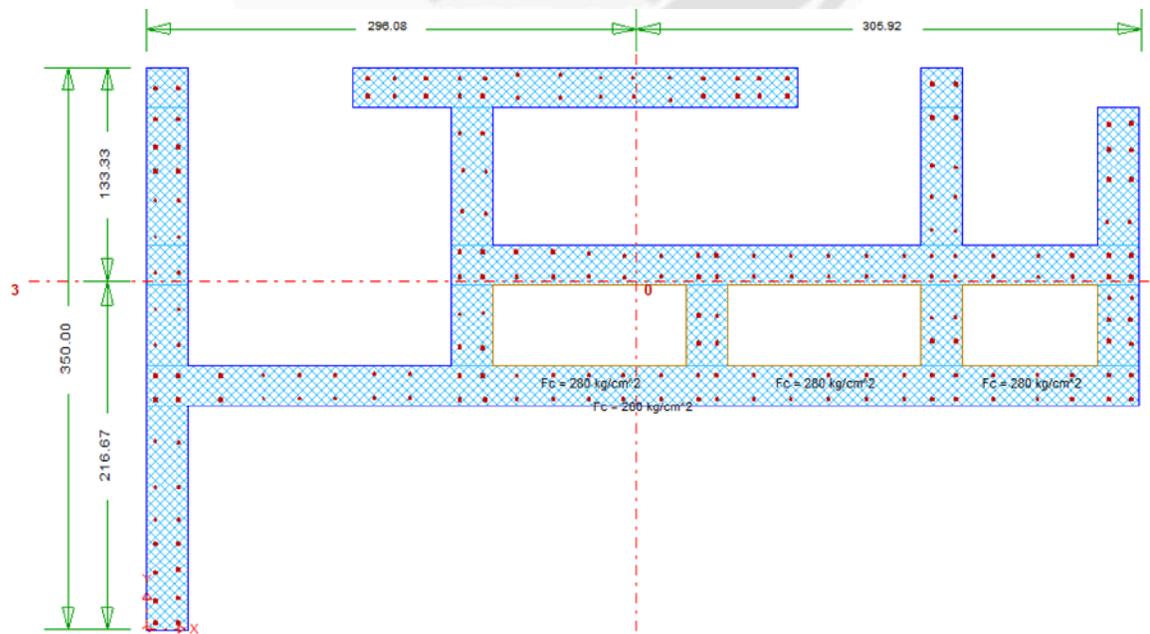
Armado Preliminar por Flexión para la Placa en Estudio PL-12.
